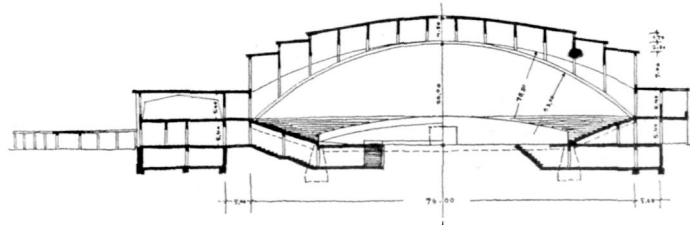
Westfalenhalle Dortmund. Querschnitt
